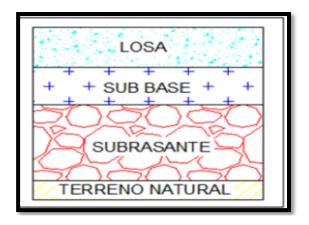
Armazón de un pavimento rígido. (Mora y Mendoza, 2016)
